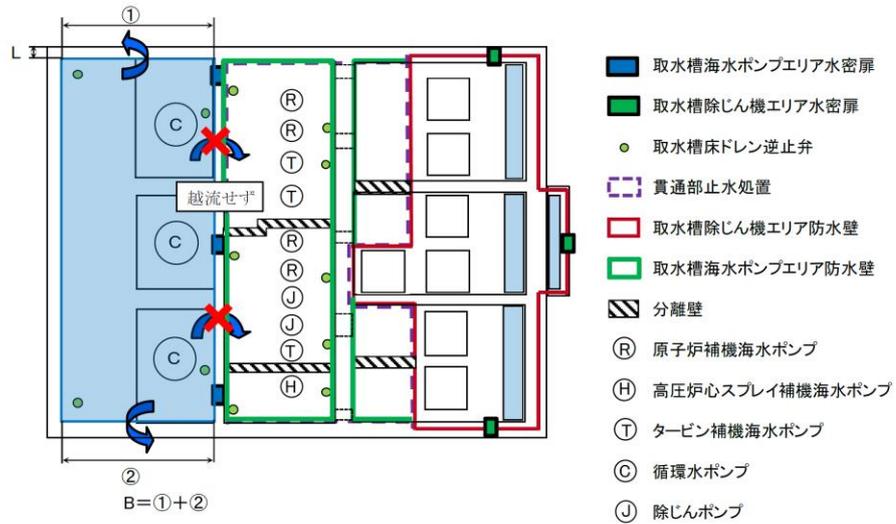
取水槽海水ポンプエリア平面図 (循環水系配管破損時)
